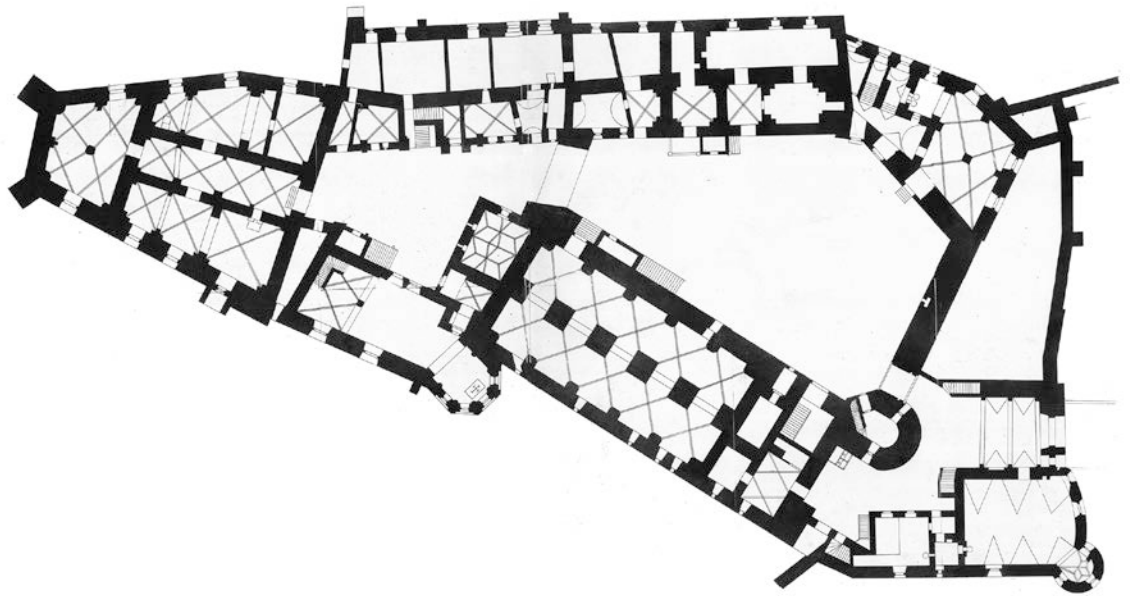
Grundriss Erdgeschoss Hauptburg Burghausen
